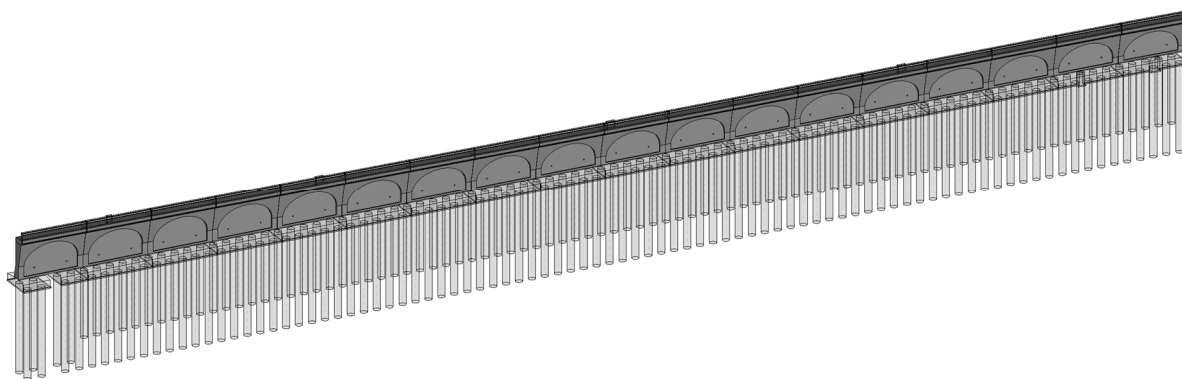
Axonometrický pohled s vyznačenými pilotami a základy
